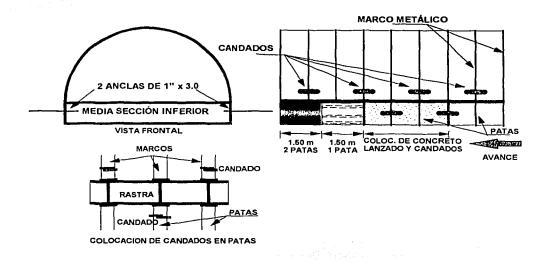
Detalle de candados en patas, longitud de avance y concreto lanzado
